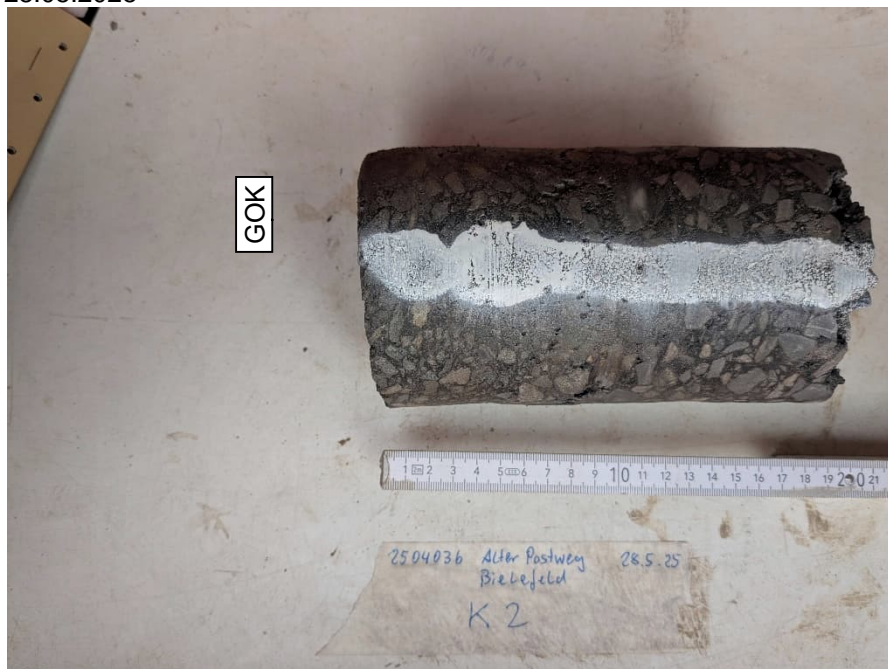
Detailfoto Kern 2/1 (0,00-0,18 m u. GOK)
